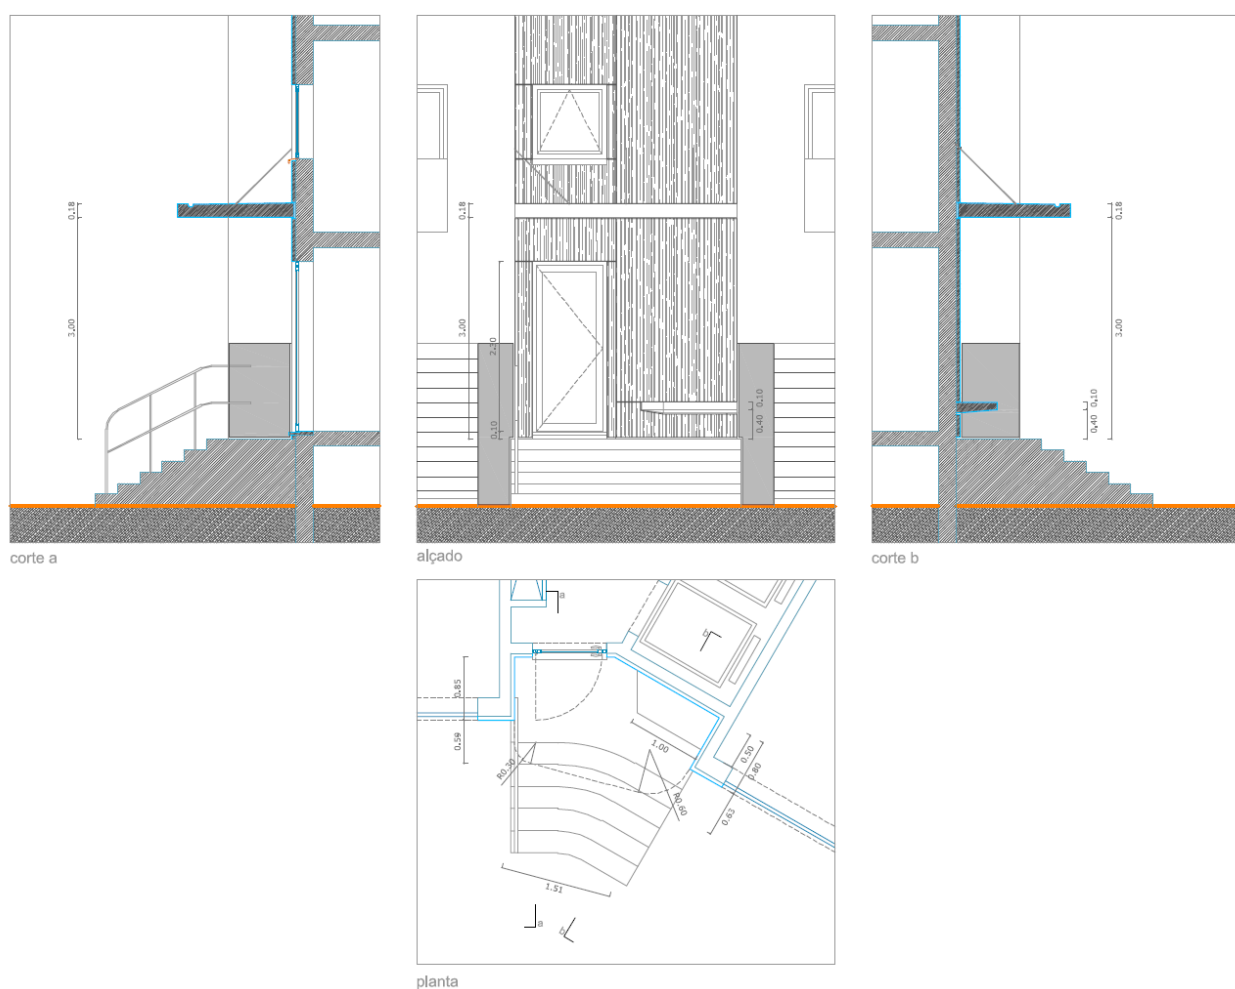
Proposta de requalificação de entrada de tipologia “ângulo”. Alçado, corte e planta (escala 1/50).
